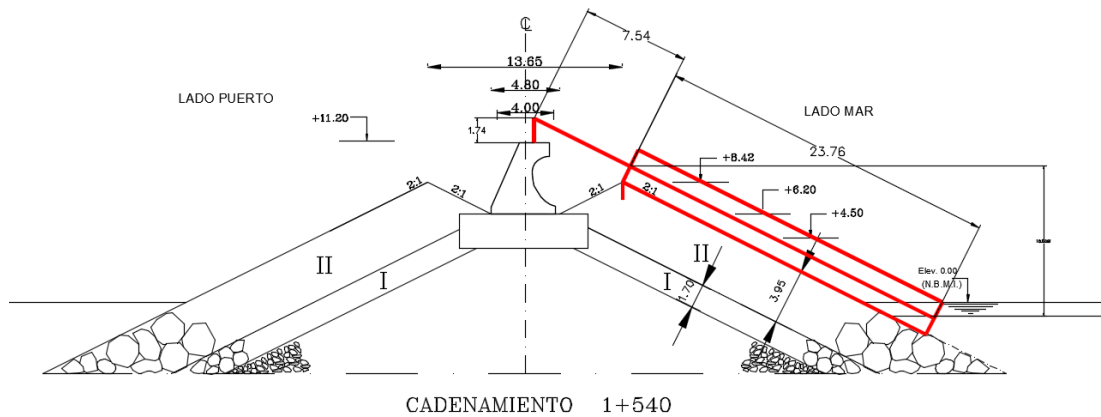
Sección transversal tipo del rompeolas del puerto de Ensenada B.C., cadenamiento 1+540
